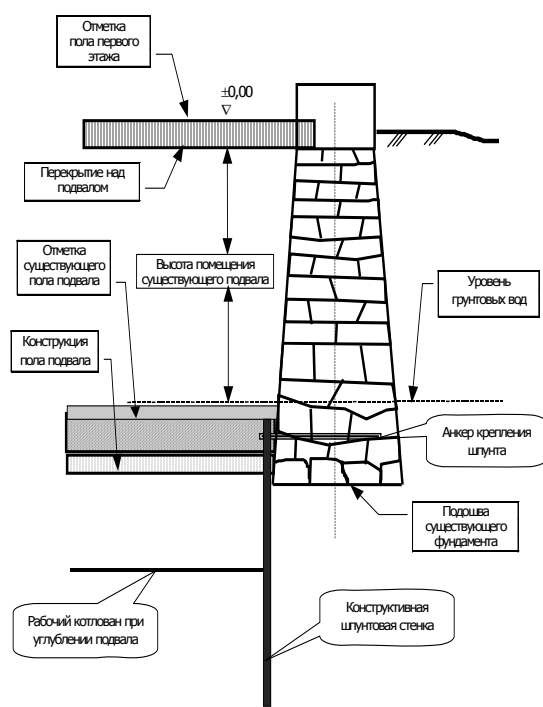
Принципиальная схема усиления основания шпунтовым ограждением для существующего фундамента при углублении подвала
